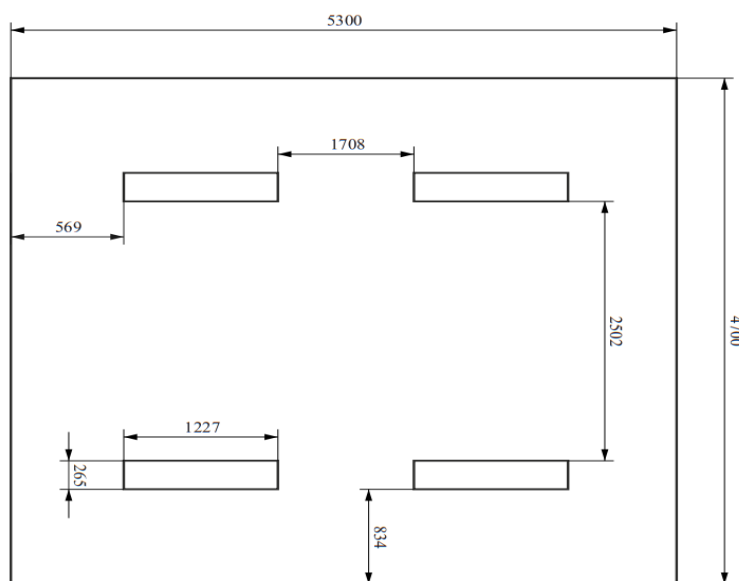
План помещения и размещения светильников с люминесцентными лампами
